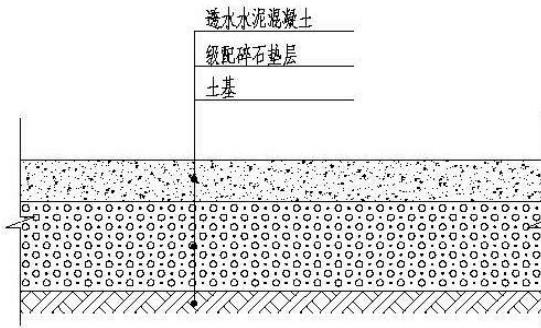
全透式透水水泥混凝土结构示意图
